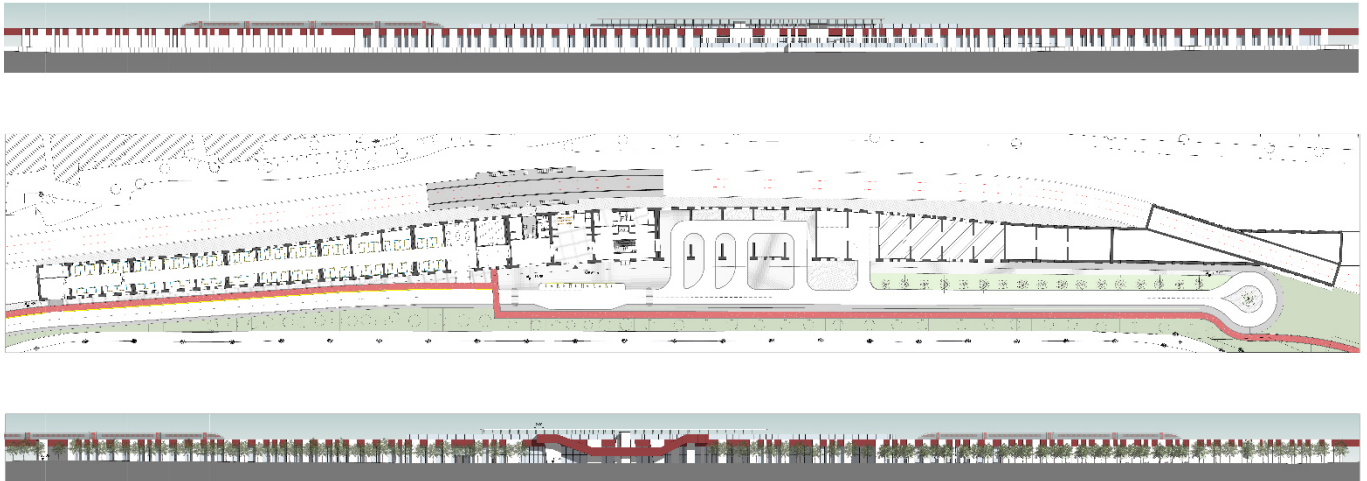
Scatolare ferroviario - Pianta piano terra, prospetti – Stazione di Tor di Quinto
